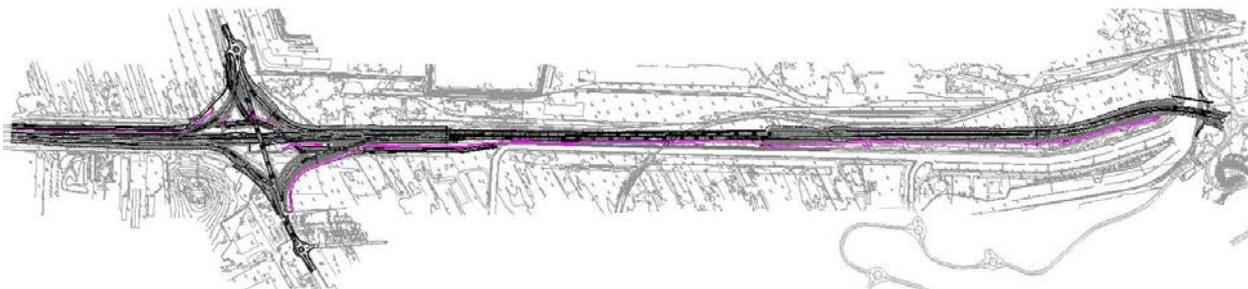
Planimetria di progetto PE (in magenta la pista di manutenzione)
